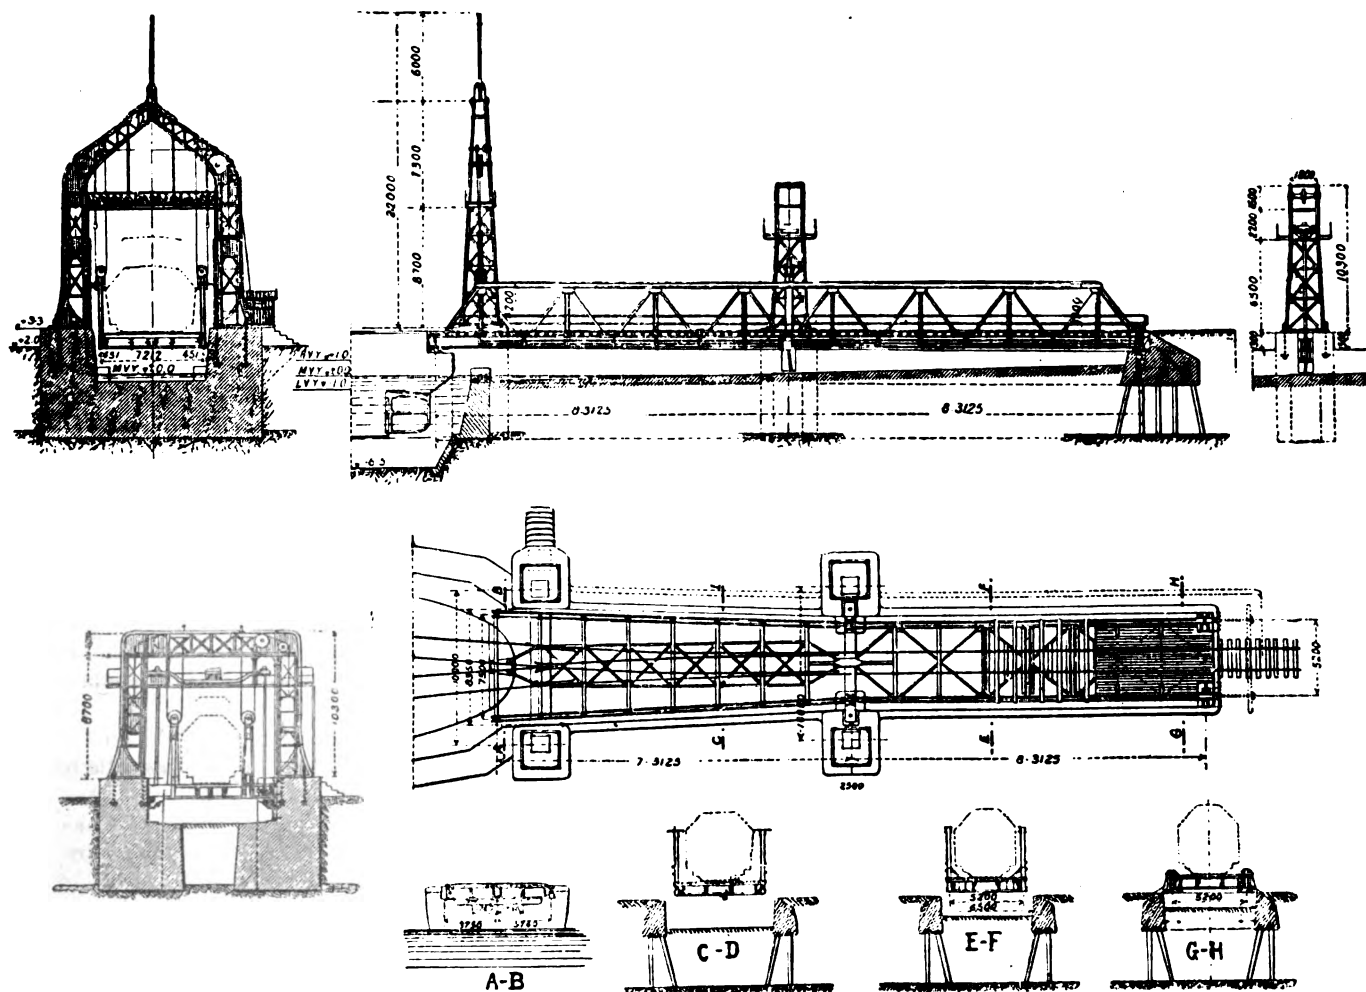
a 30 — Pontile d'approdo - Elevazioni, piante e sezioni.
